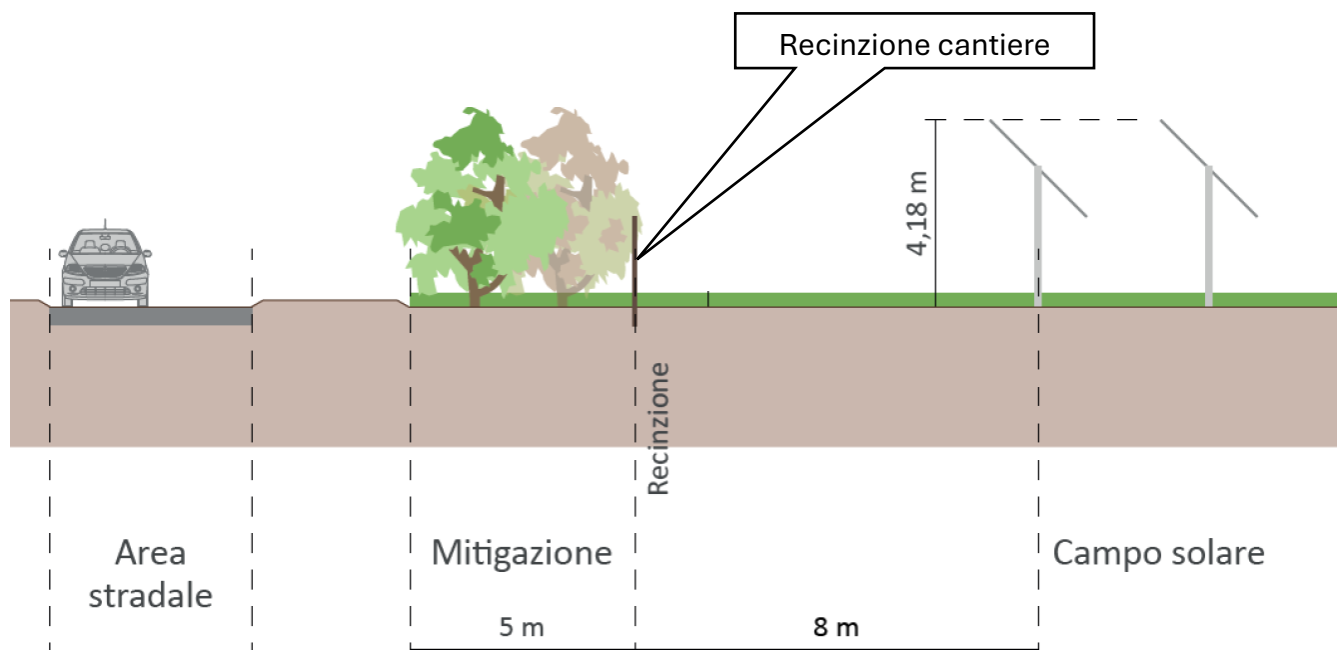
Sezione tipologica strada-mitigazione-recinzione
